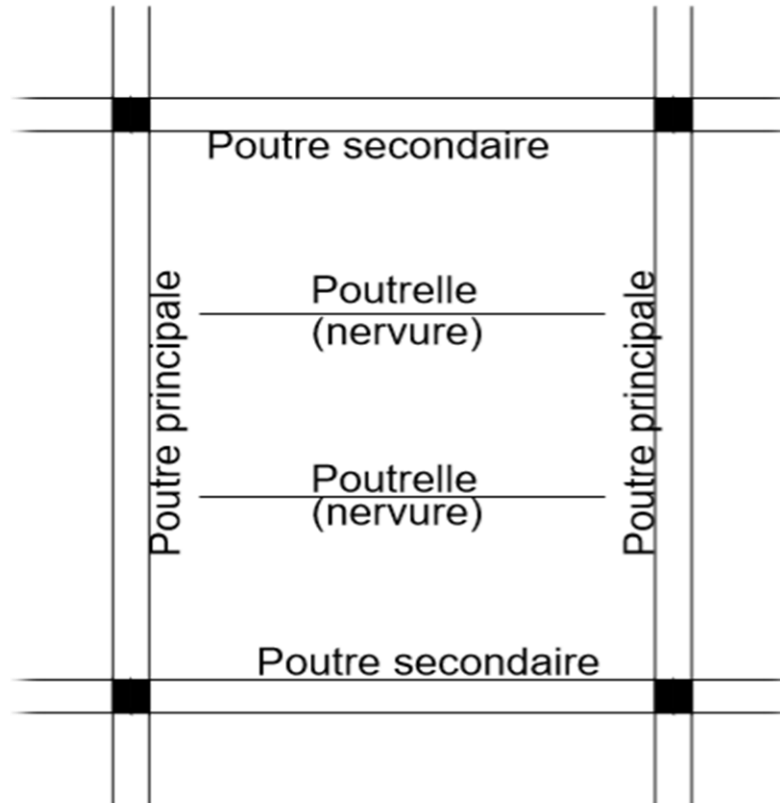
Représentation d'un plancher en corps creux composé de poutrelles sur lesquelles repose le corps creux
